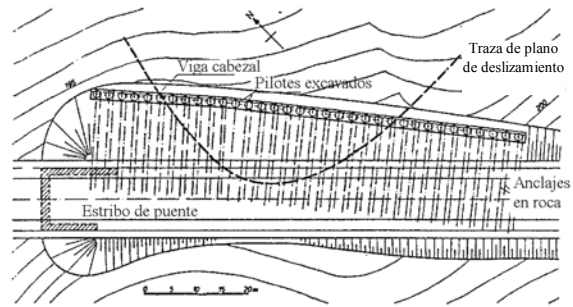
Vista en planta de obras de estabilización (Witcher et al, 1988).
